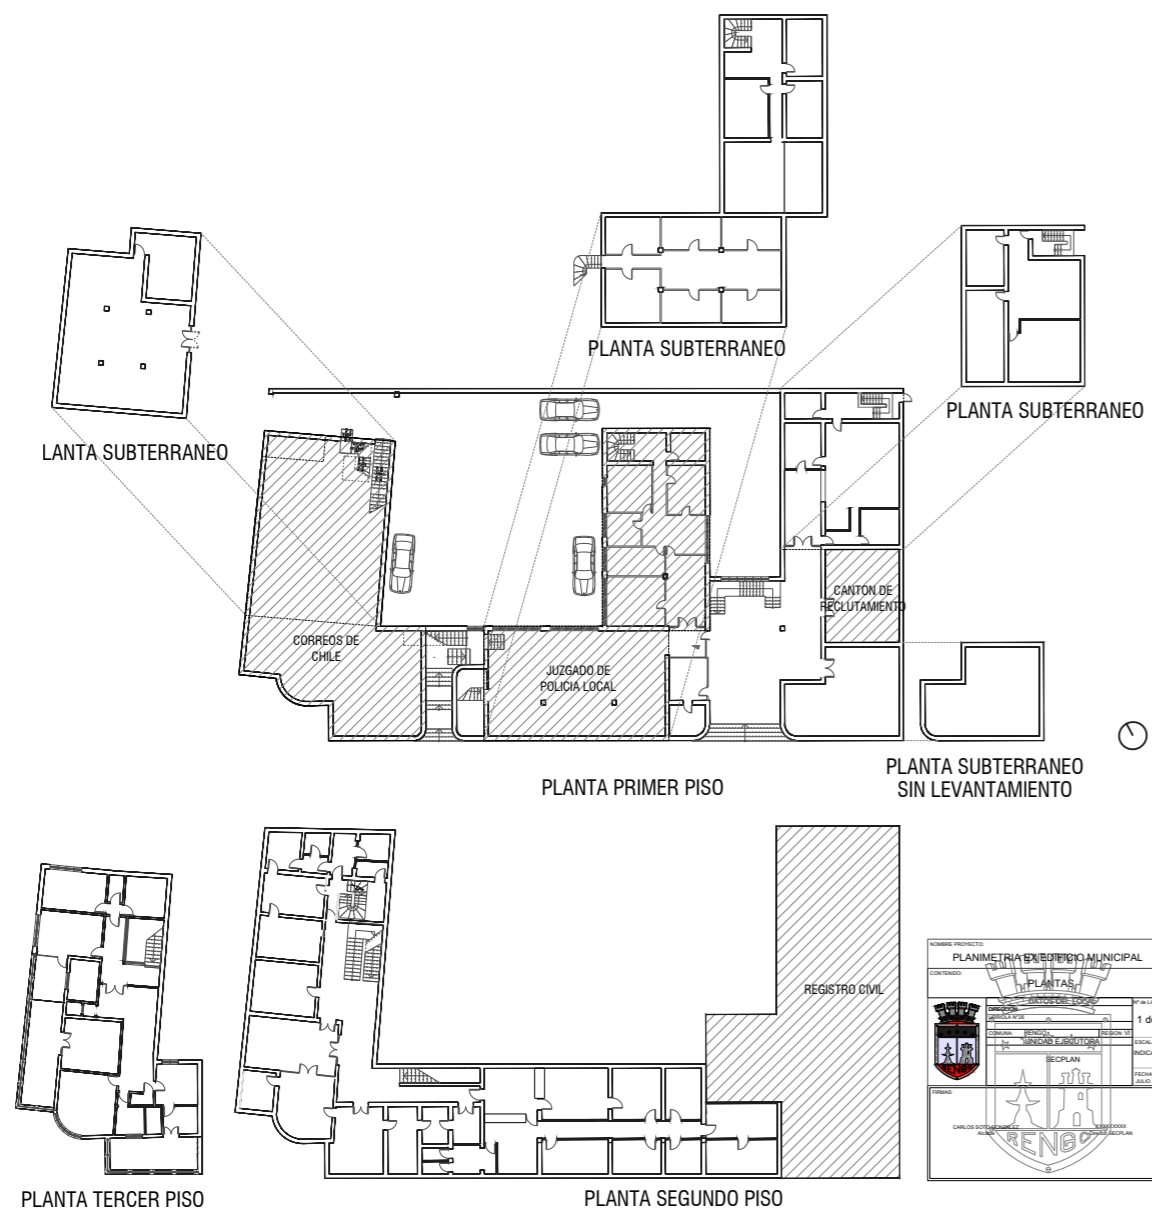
Planimetría ICH Ex Gobernación de Caupolicán Rengo. Planimetría obtenida de Archivos de la Ilustre Municipalidad de Rengo, SECPLAN.
